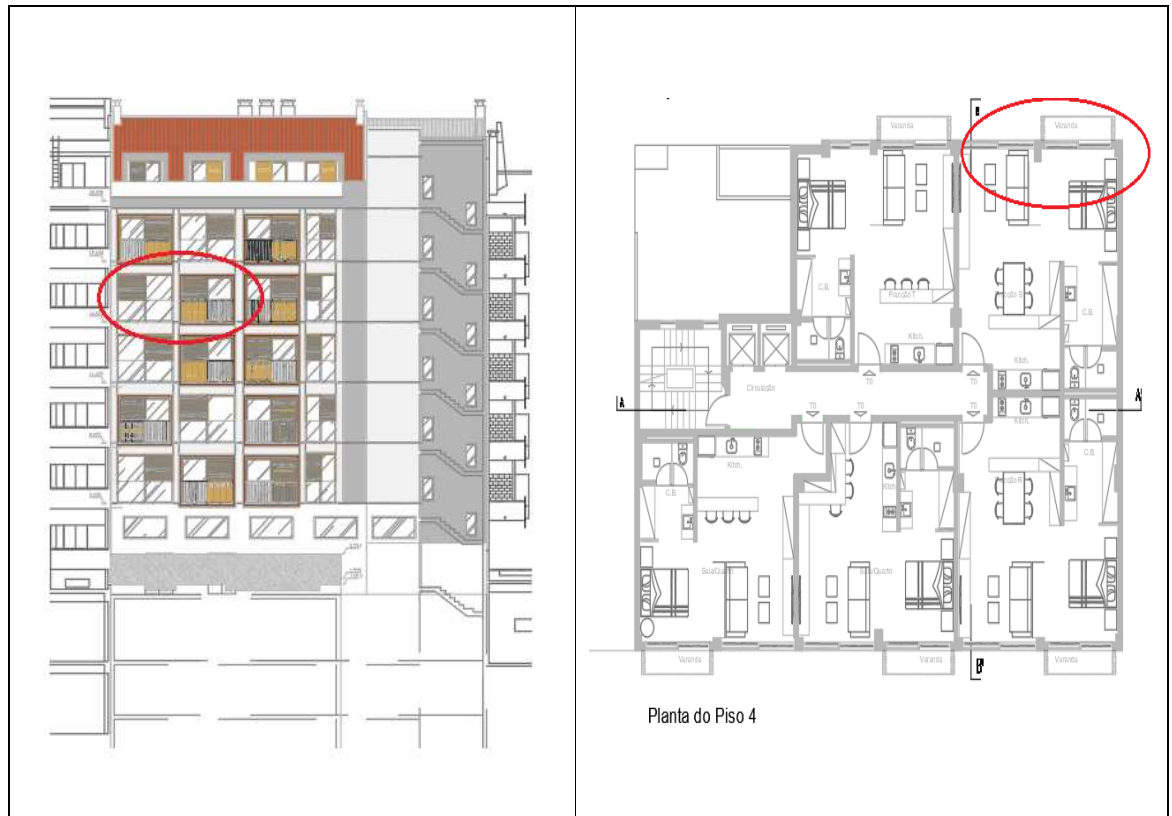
Divergência entre planta e alçado, no projeto de arquitetura, no piso 4.
